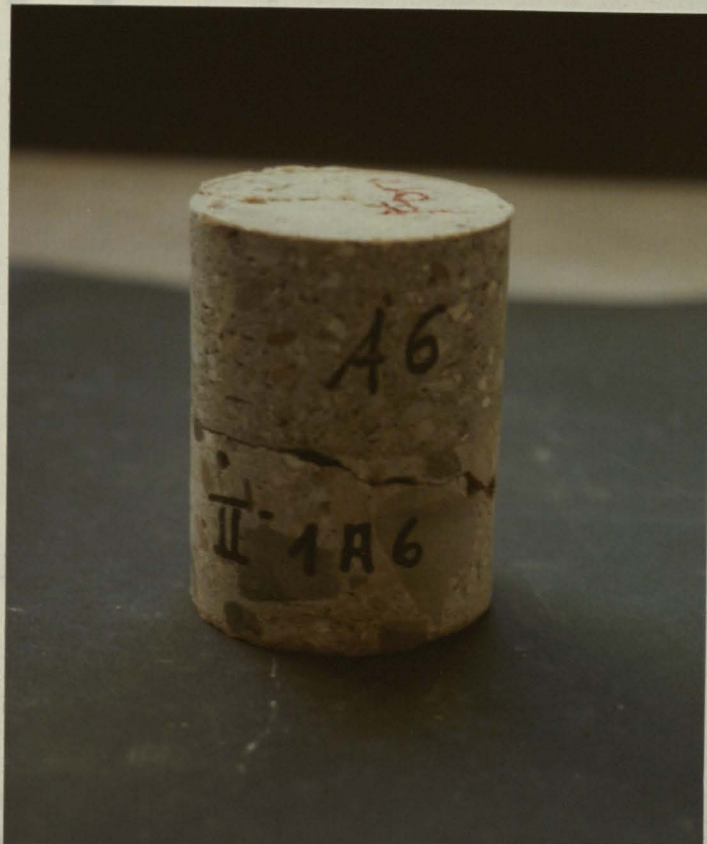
Mischbruch Fuge/Grundbeton - Ansicht
